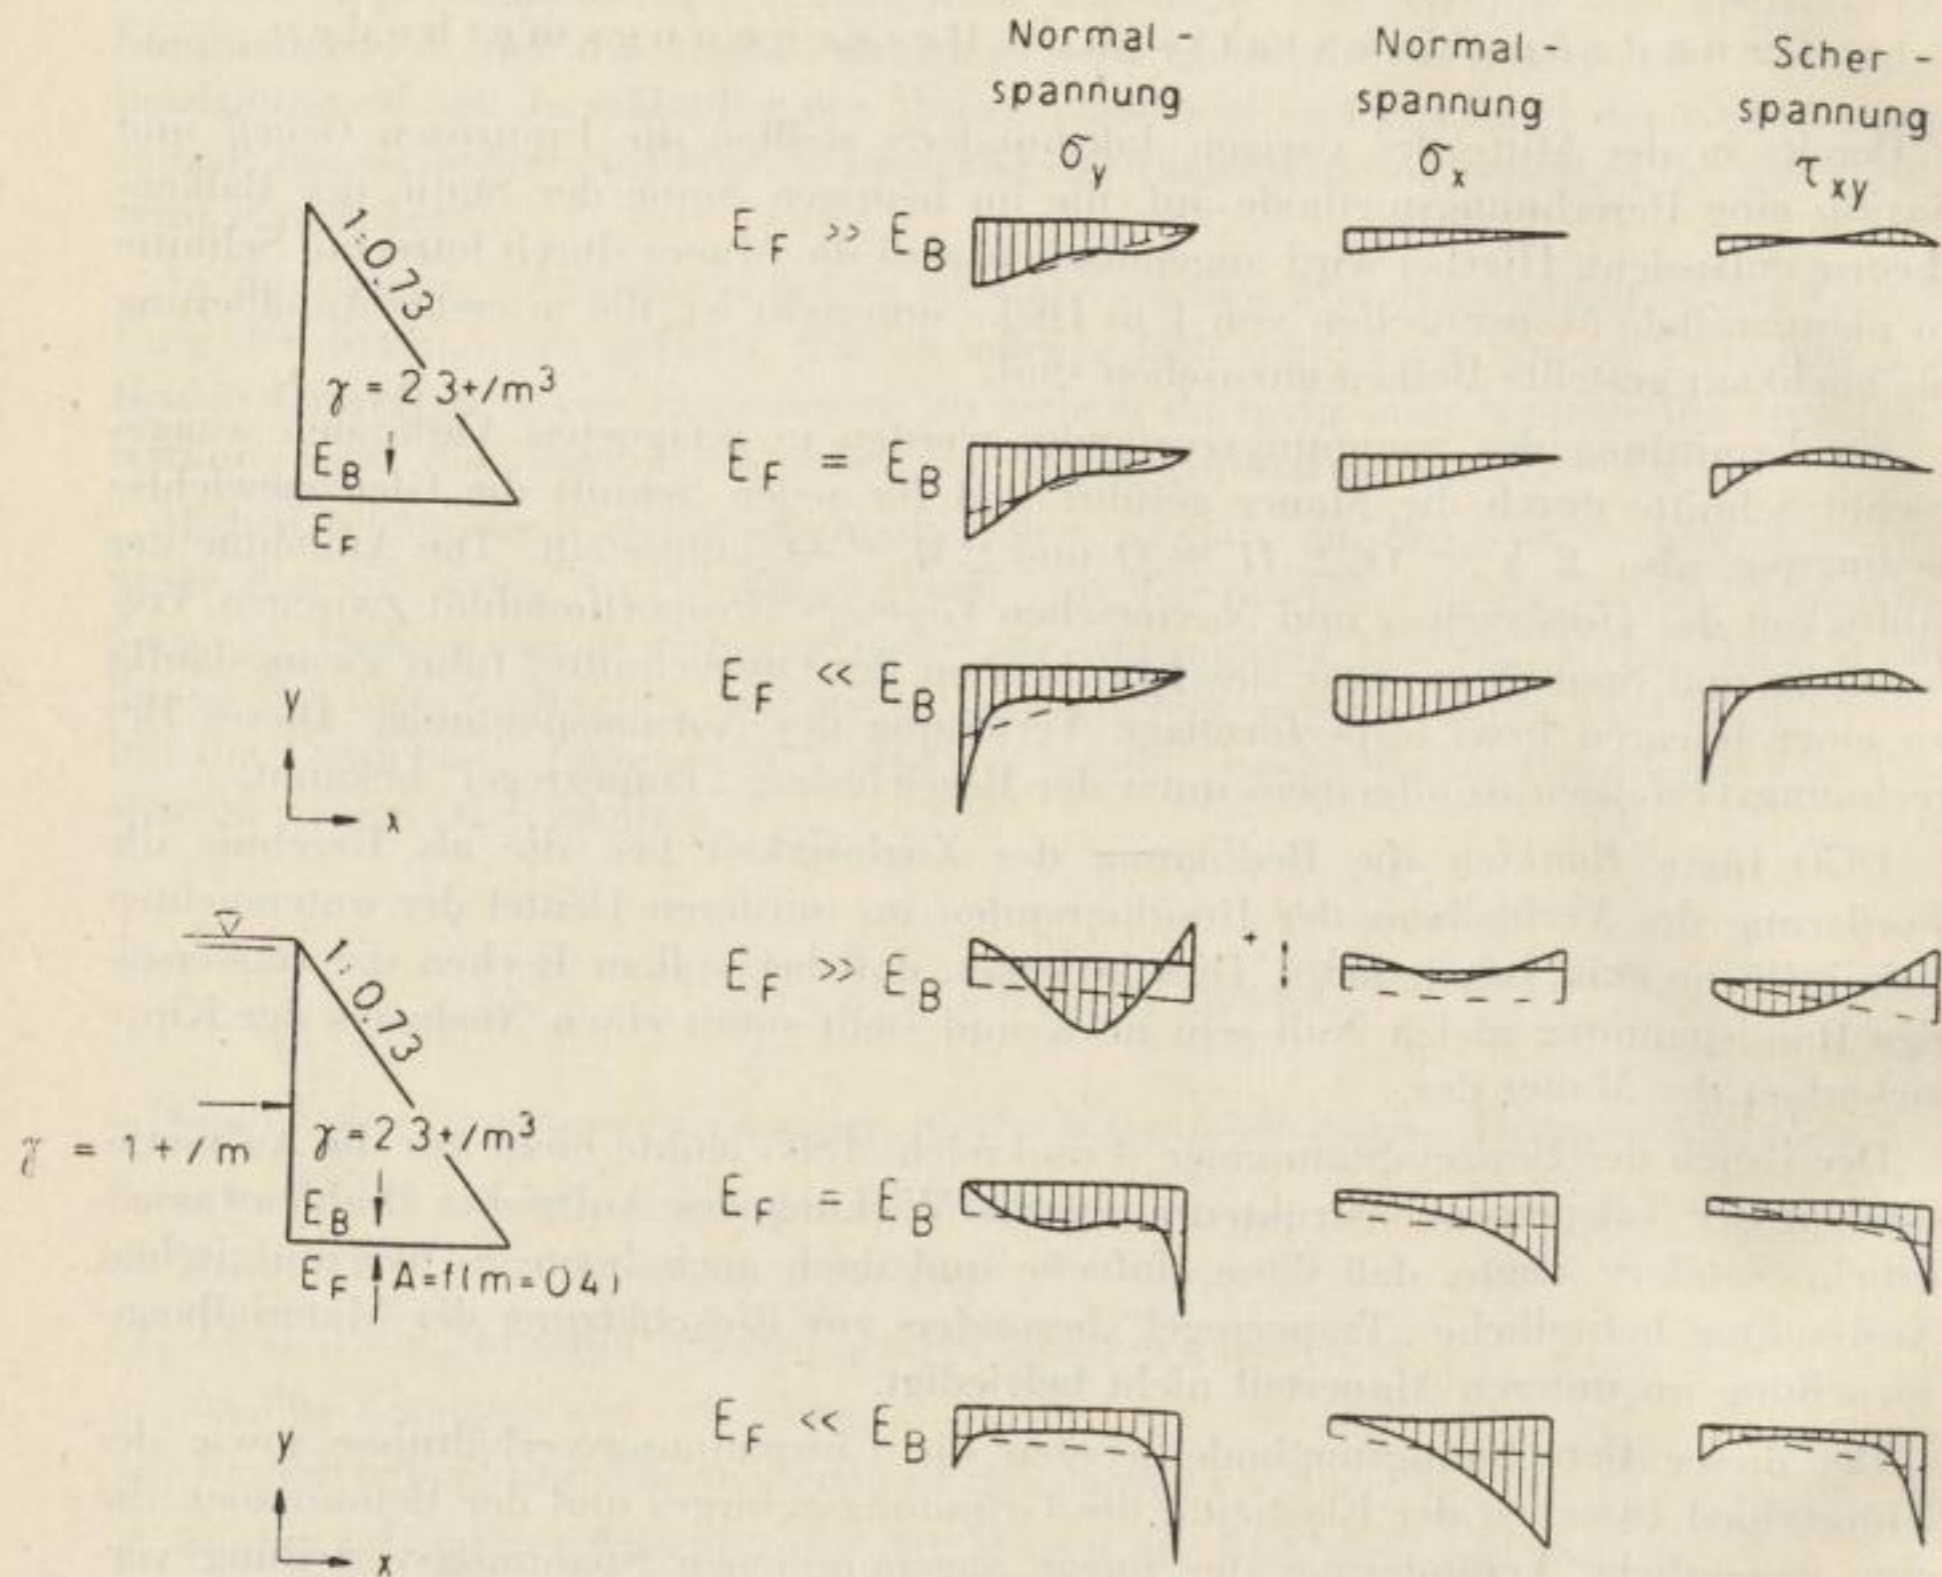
Spannungsverteilung im Gründungsbereich unter Berücksichtigung der Baugrundelastizität nach elastizitätstheoretischer Grundlage (gestrichelte Linie nach Trapezregel)
